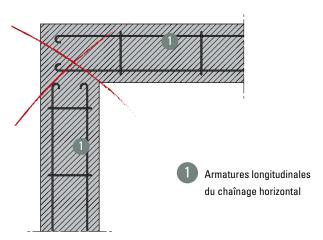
Exemple de liaisons entre armatures de chaînages horizontaux – Disposition incorrecte
